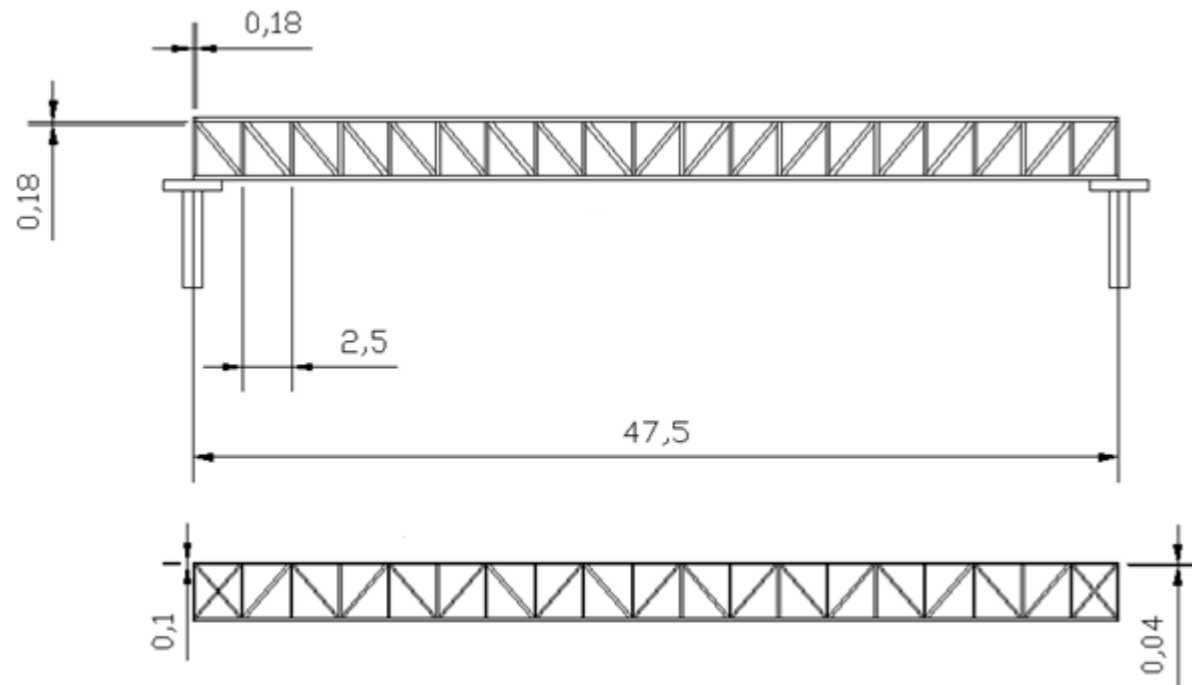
Alzado y planta pasarela peatonal tipo Pratt.
